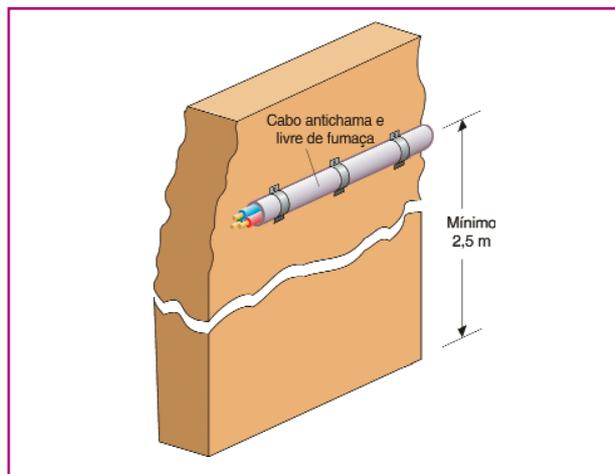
Instalação em linha aparente com cabo diretamente fixado, em locais BD3 e BD4
